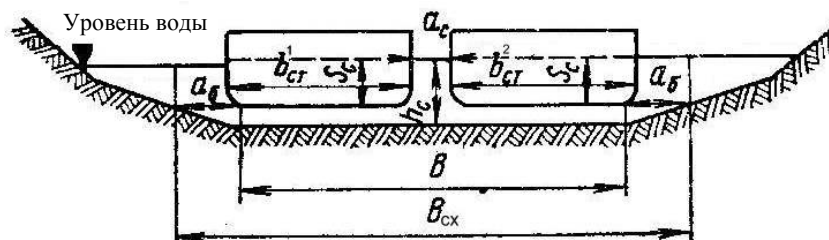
Схема для расчёта ширины двустороннего судового хода
